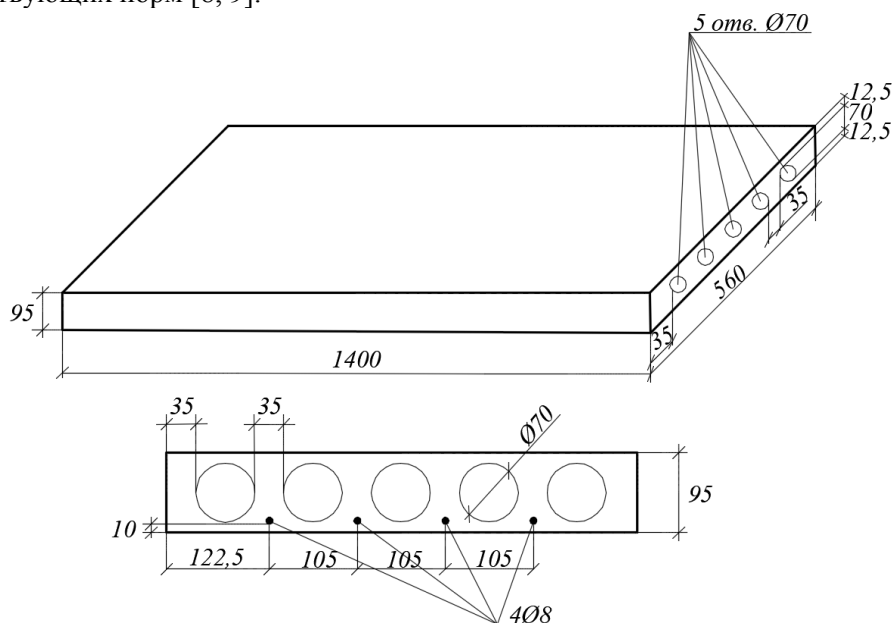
Модель железобетонной многопустотной плиты перекрытия
